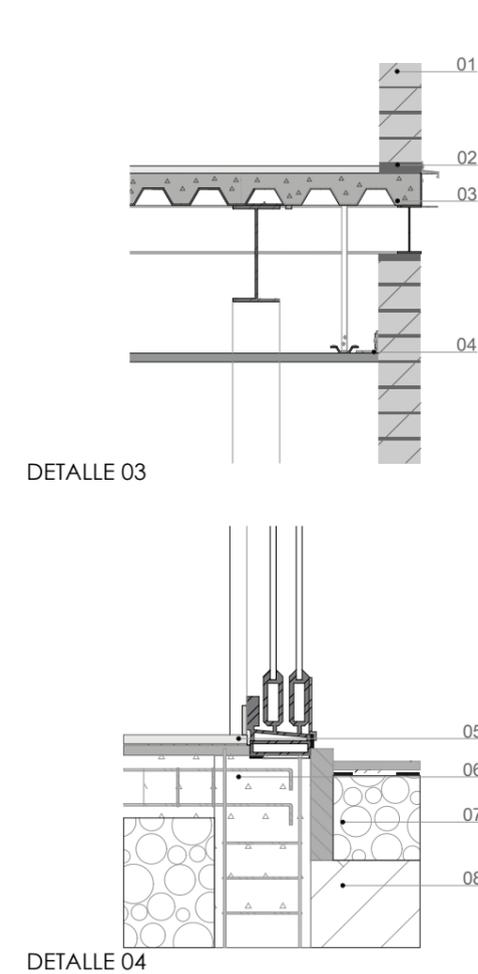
y 101: Detalle constructivo Fuente: Elaboración propia
